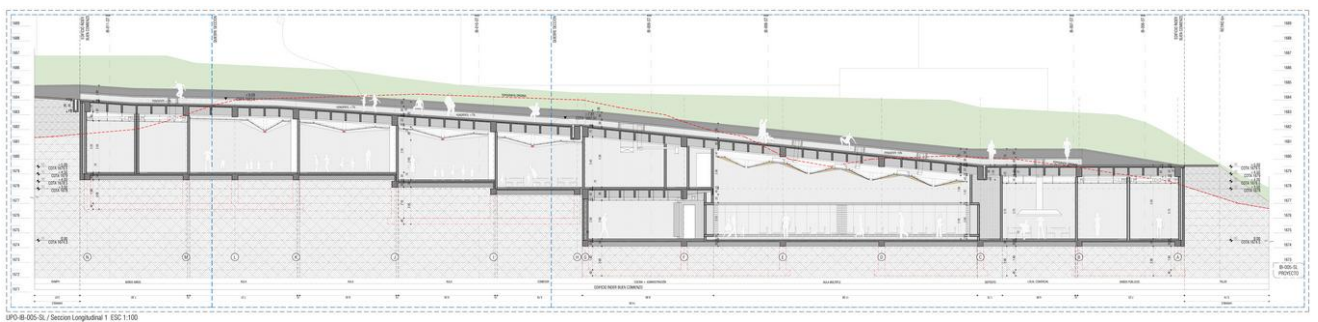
Corte Transversal do Edifício Jardim Buen Comiezo. Fonte: site EPM.
